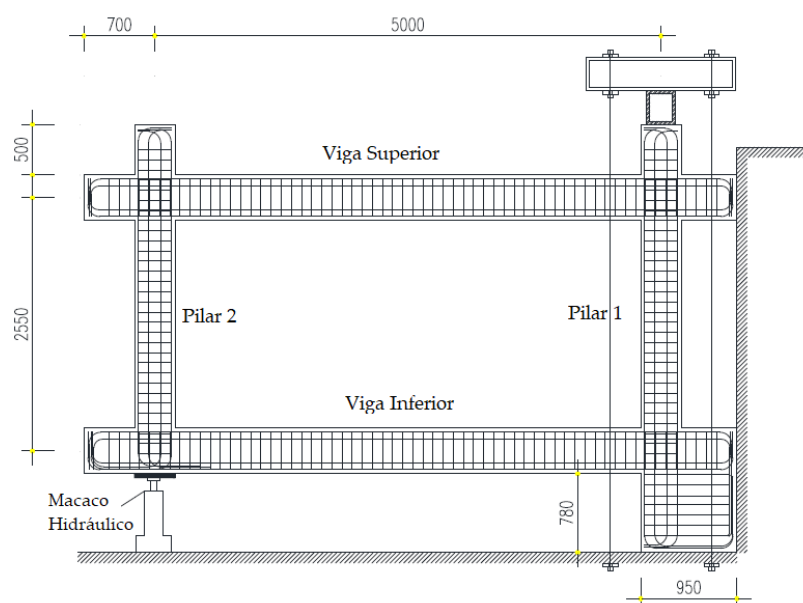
Pórtico de betão armado e respectivas armaduras (adaptado de [32]).
